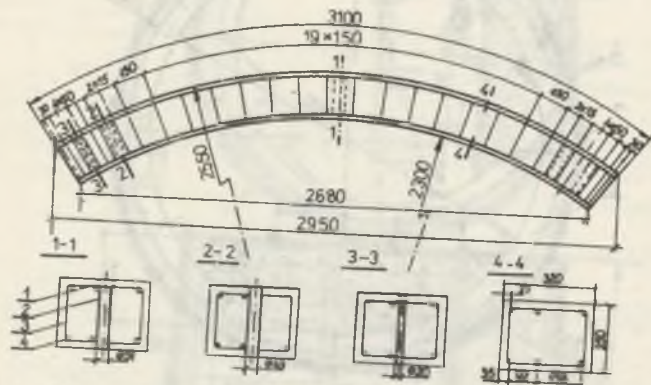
Konstrukcja pierścienia segmentowej obudowy żelbetowej złożonego z 6 segmentów
